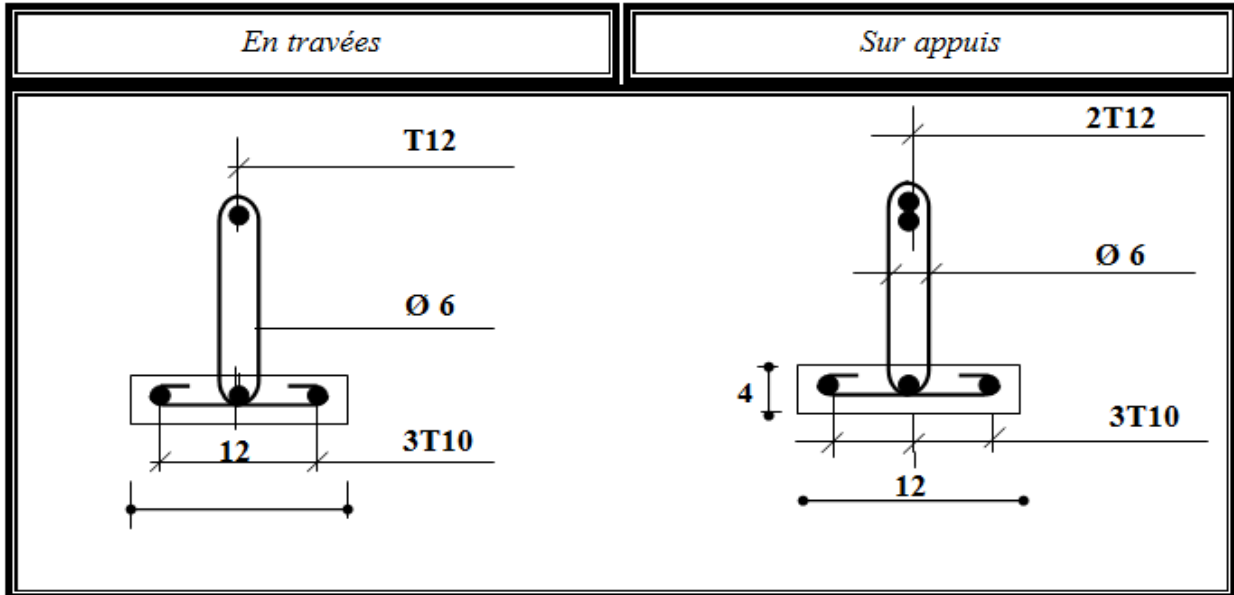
Schéma de ferrailages des poutrelles pour RDC jusqu'à 9^{ème} étage
